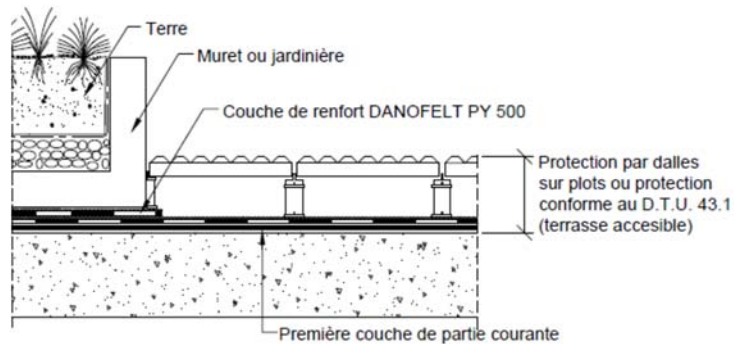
bis – Exemple de mise en œuvre du complexe POLYDAN JARDIN – Cas des murets construits sur le revêtement d'étanchéité sur éléments porteur en maçonnerie (cf. § 2.4.8.6)
